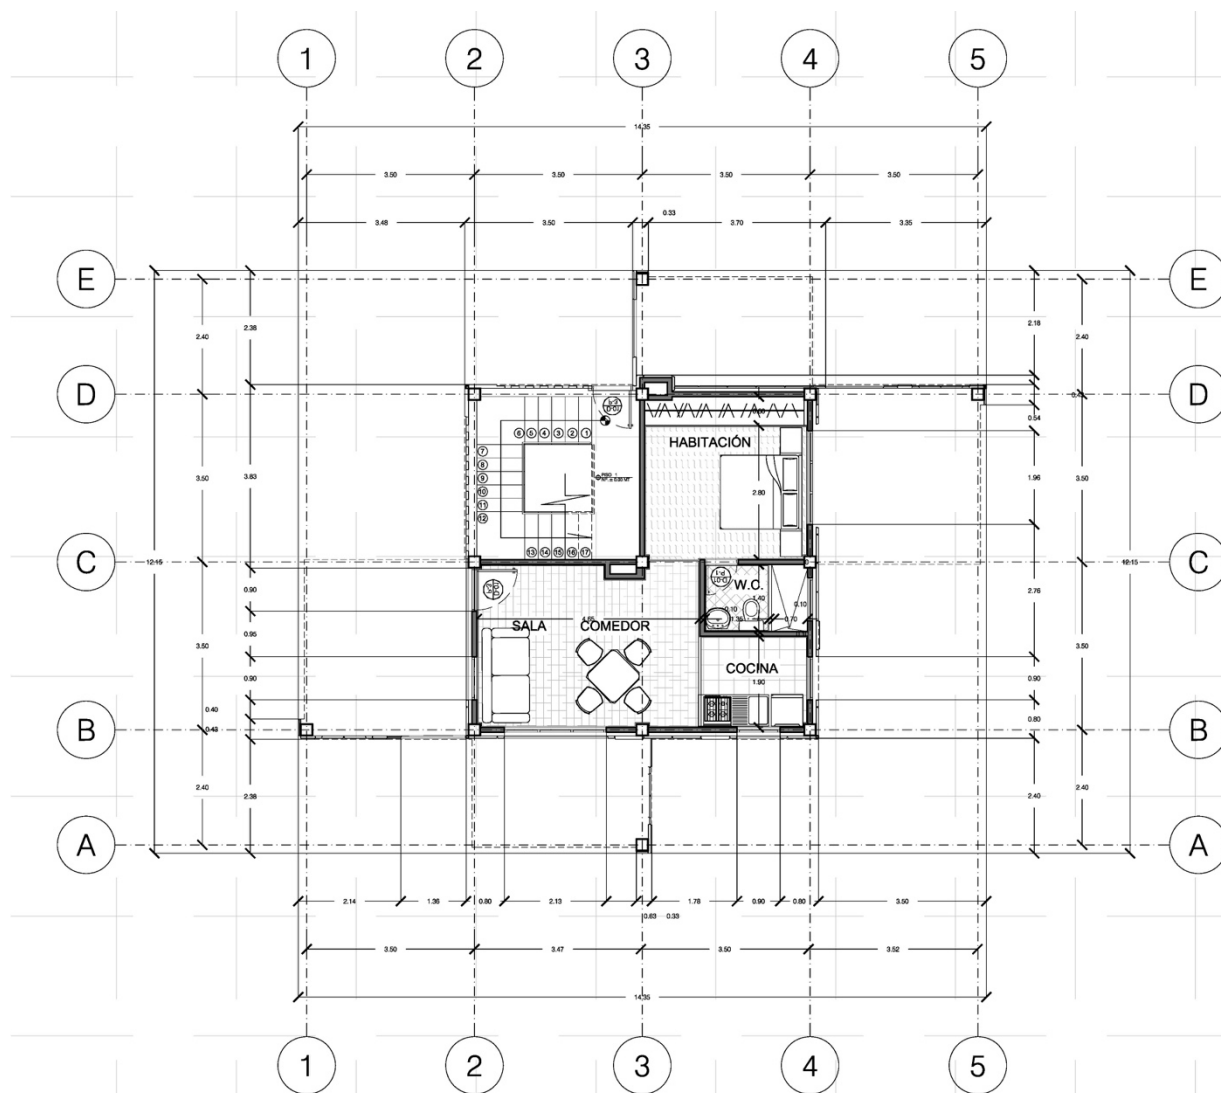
Planta arquitectónica primer piso “Zona productiva de uso mixto (hotel)”
